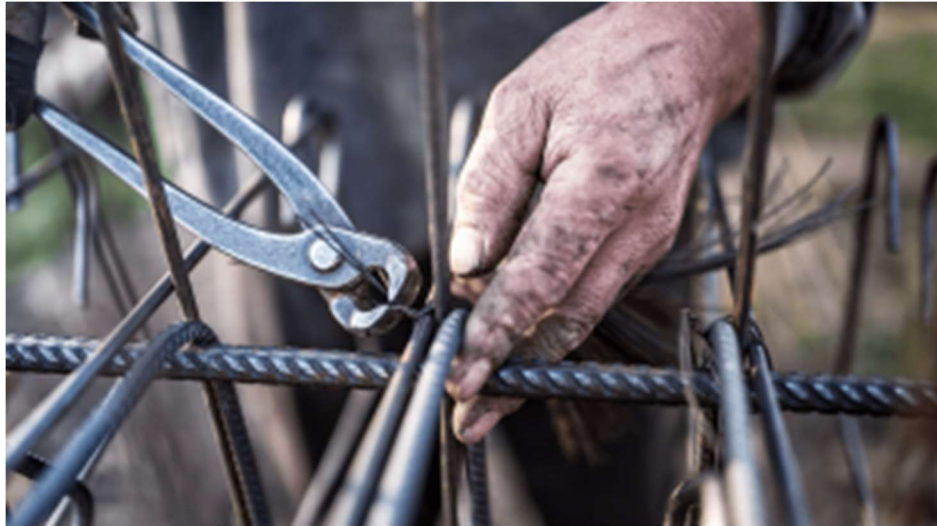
Conexão entre armaduras - Fonte: blogpraconstruir
